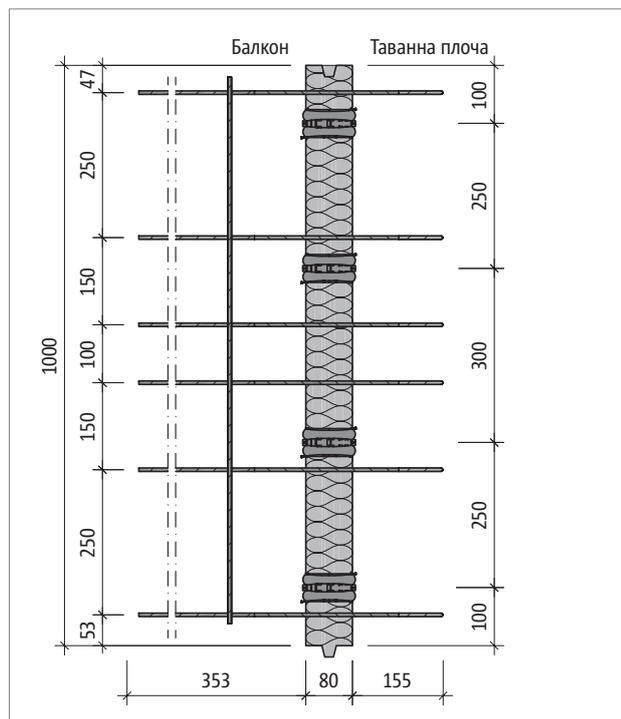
Schöck Isokorb® T mun QL-VV4: Сечение на продукта
